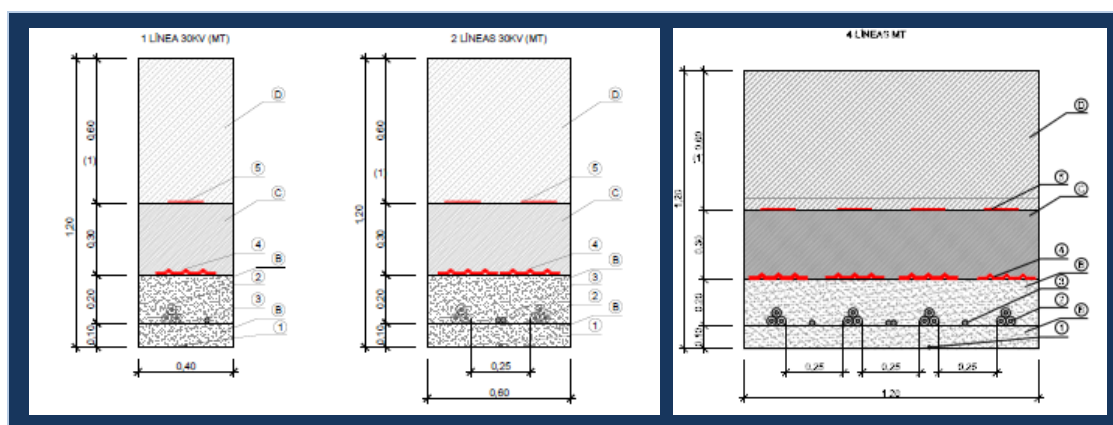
Detalle Sección Zanja. Tipo conductor directamente enterrado. (Lateral vial o por tierras)
